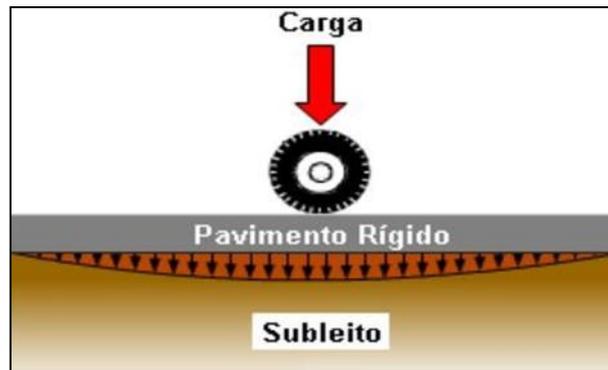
Esquema de camadas dos pavimentos rígidos
